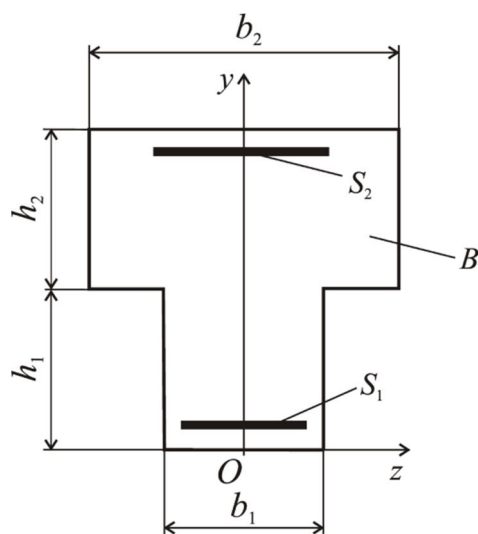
Поперечное сечение железобетонного ригеля:
